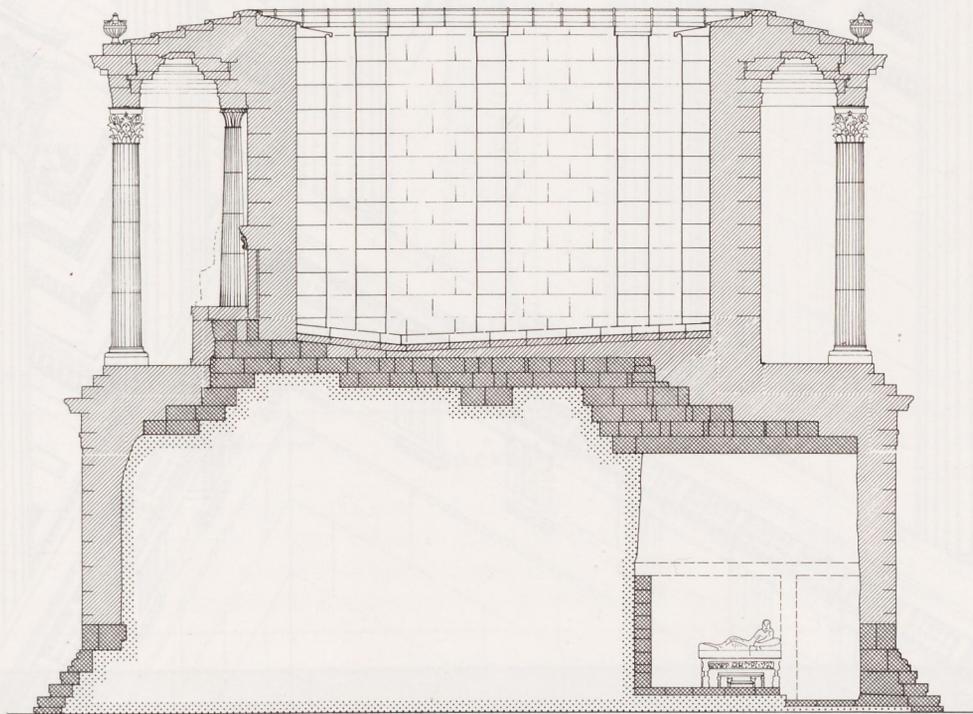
Rekonstruierter Schnitt durch das Mausoleum mit einem nicht begehbaren Hof im Obergeschoß
